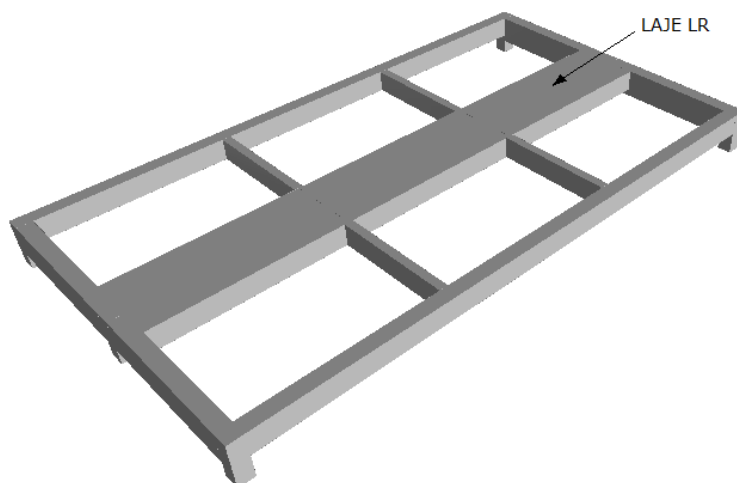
Forma do pavimento com a laje isostática unidirecional e biapoiada LR.
